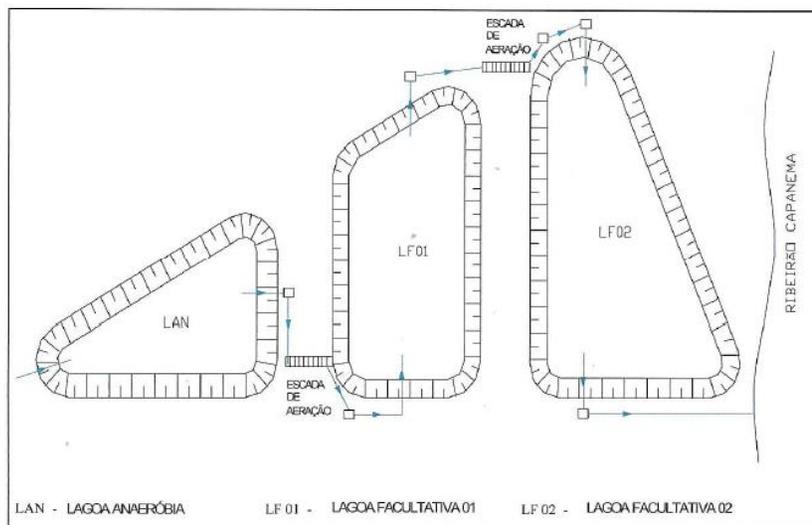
Planta baixa do sistema de Lagoa de estabilização (ALBANO, 2014)
